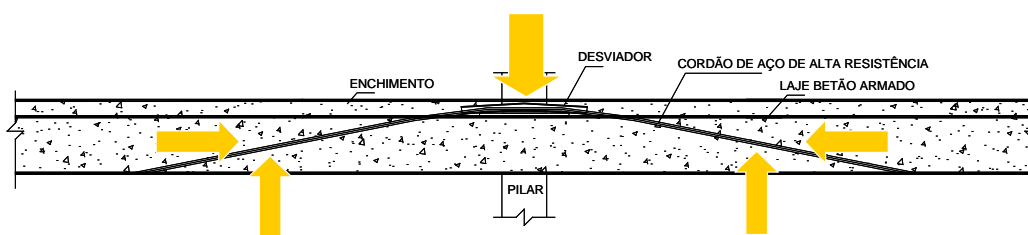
Aspeto final de uma laje reforçada [16-19]
